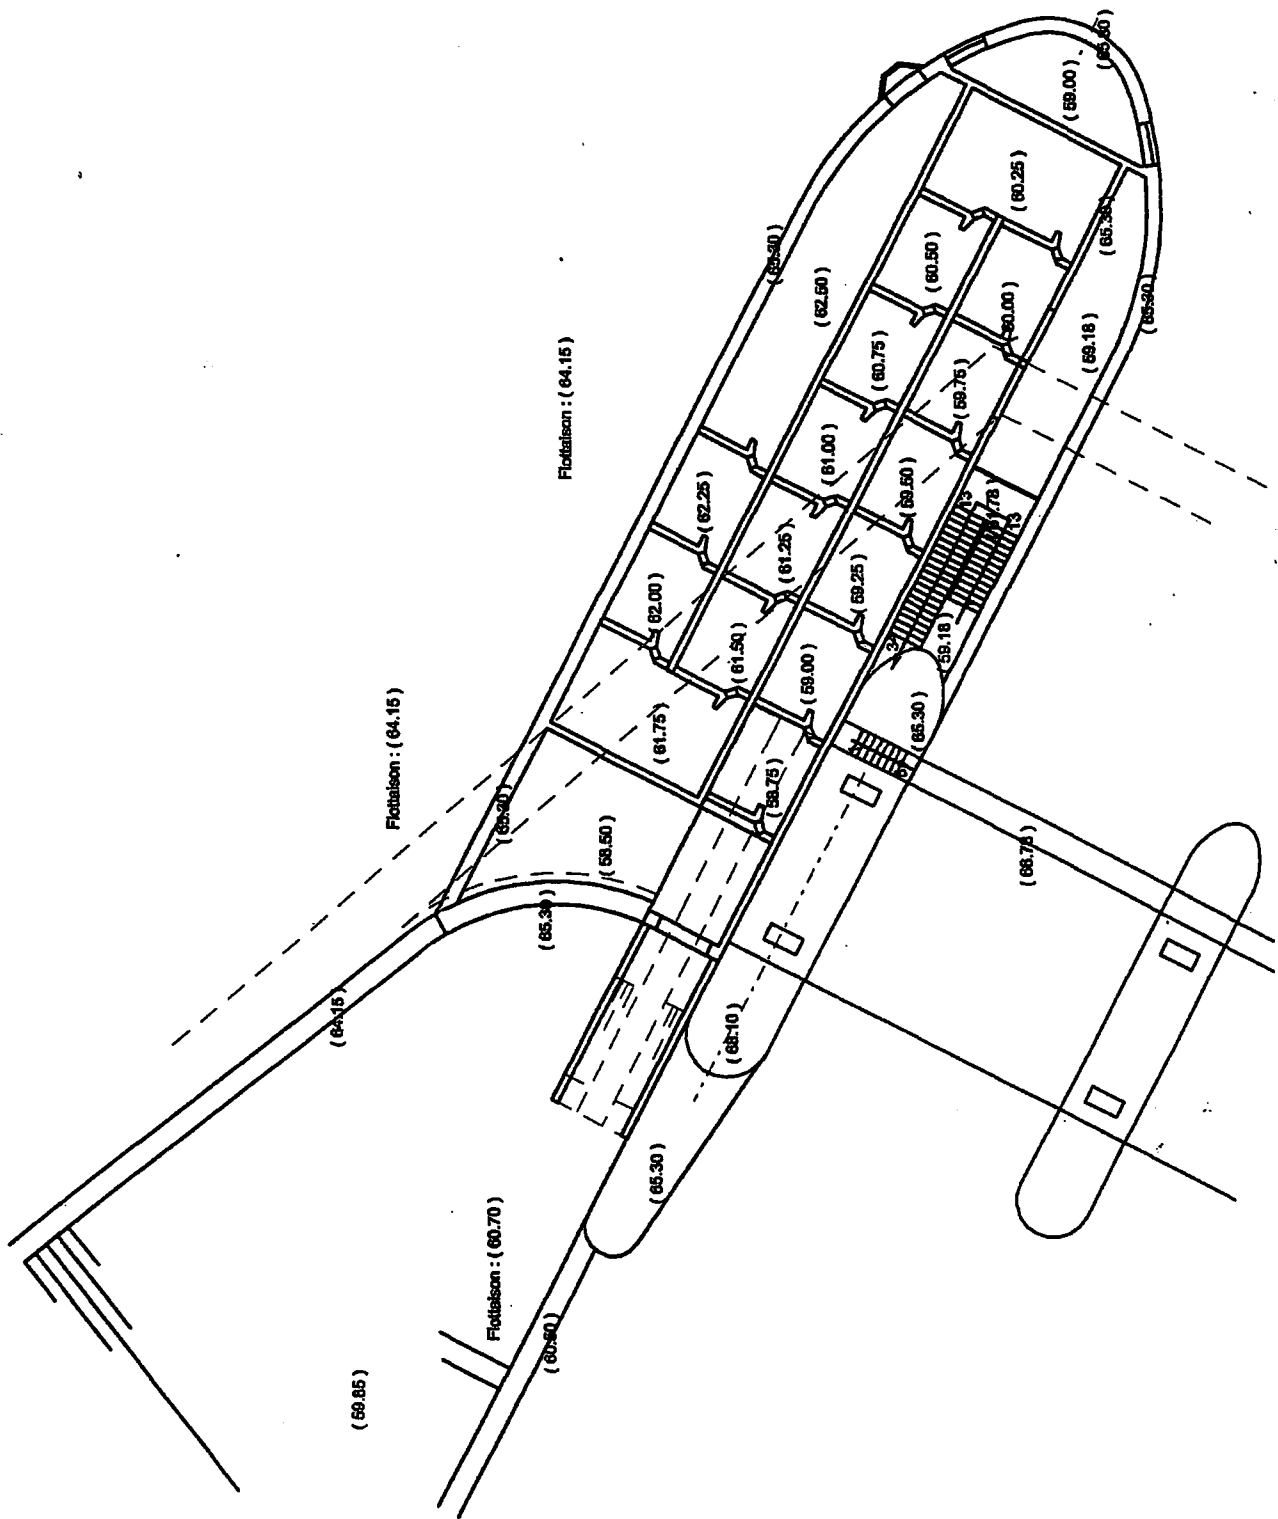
/5. Plan de la nouvelle échelle à poissons à construire par le MET sur la basse Ourthe au barrage des Grosses Battes à Liège-Angleur (source du document MET).
